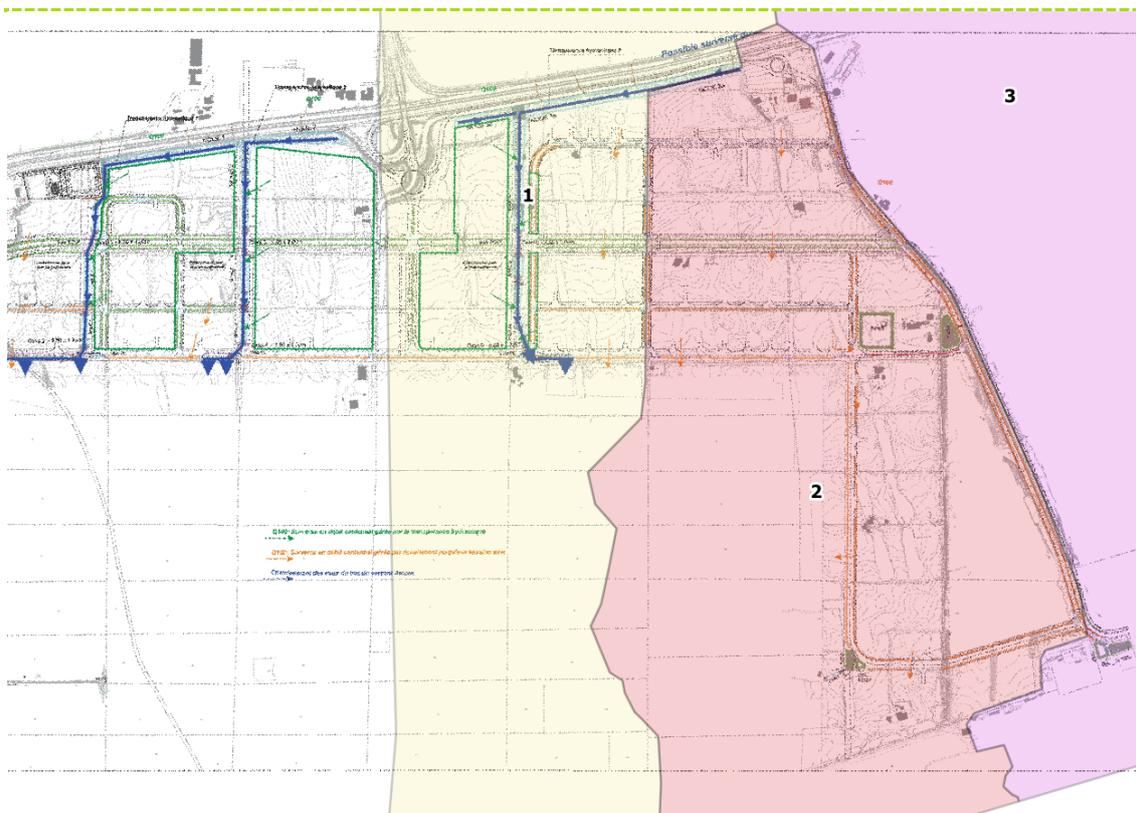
Plan des réseaux pluviaux de la ZAC Pierrefonds
